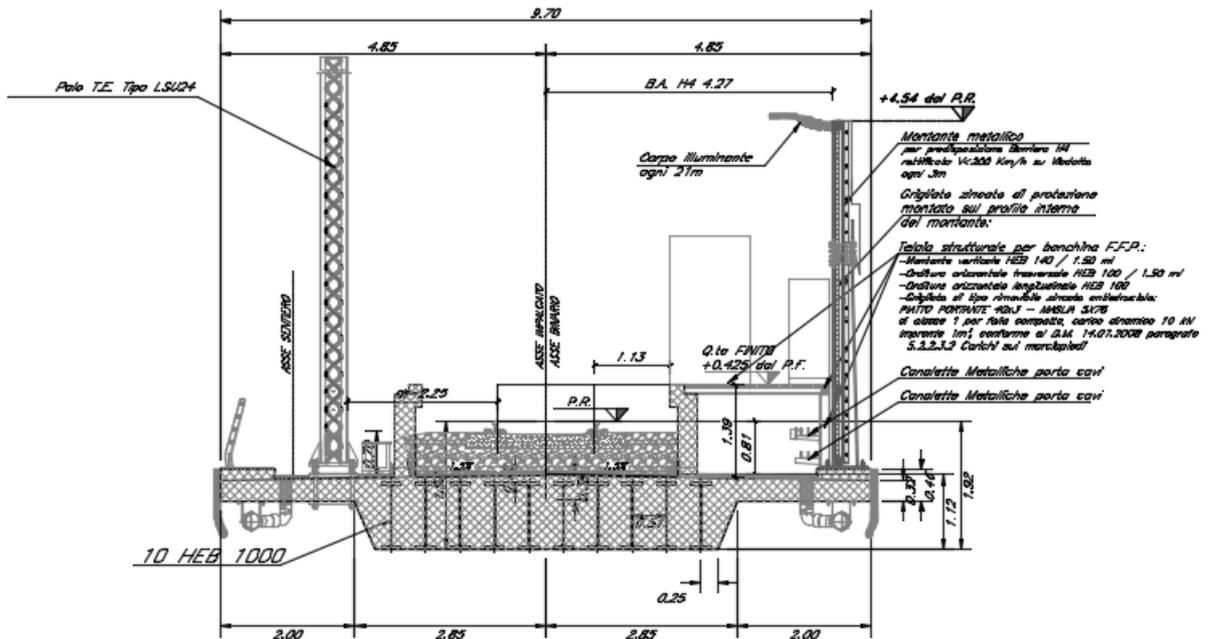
Viadotto Letojanni: sezione trasversale e prospetto binario pari
